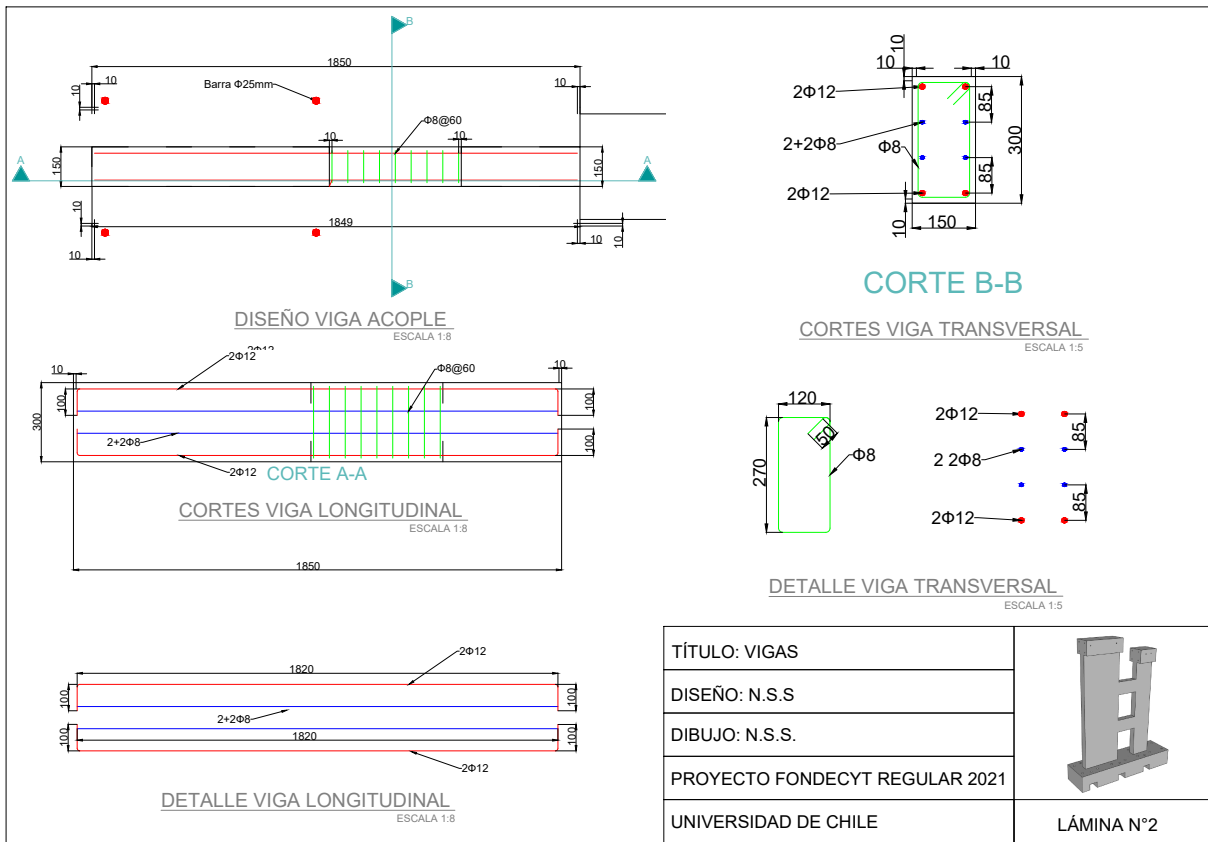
Plano Vigas de Acople de la Probeta CWB
